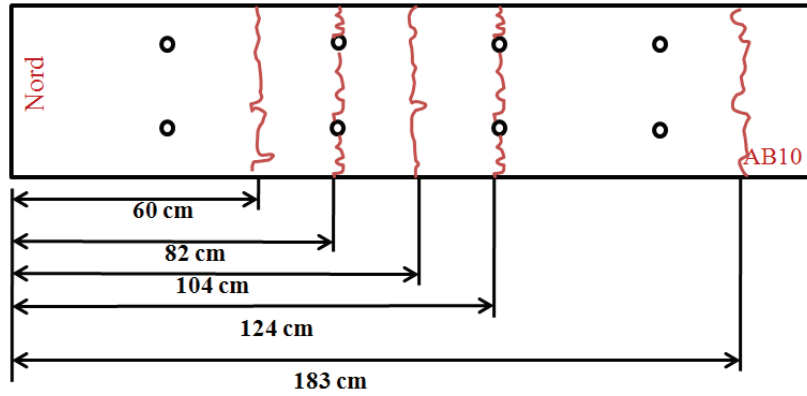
Relevé des fissures sur la poutre AB10
